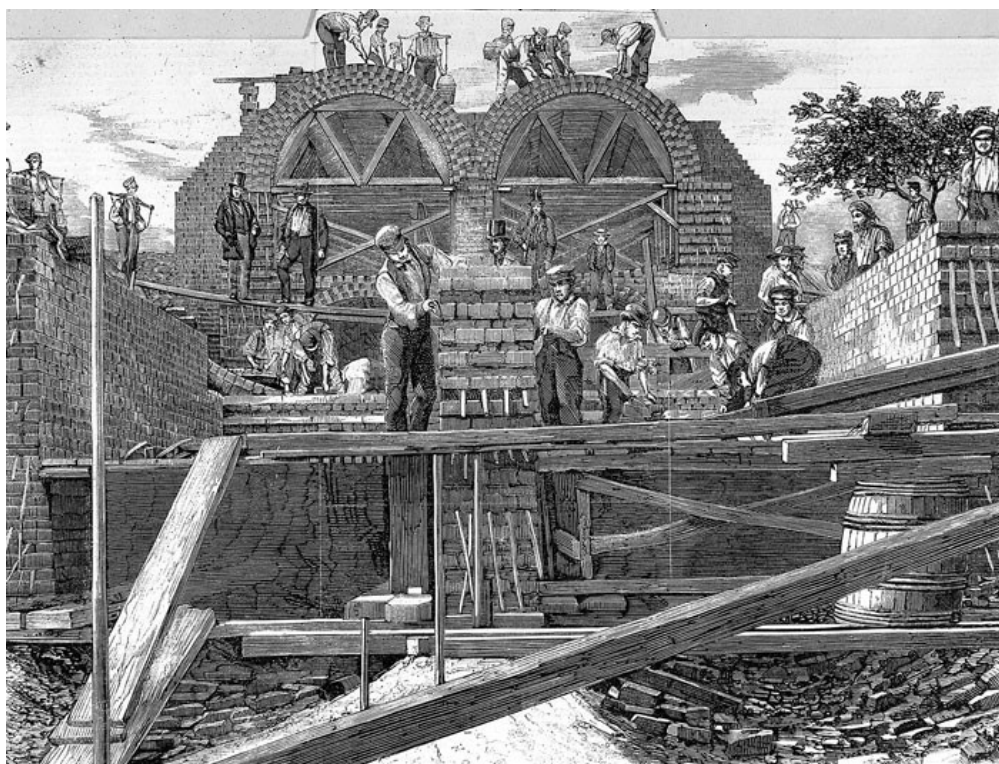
Construcción de alcantarillas en 1859, Londres. Fuente: Wellcome Library, London.
